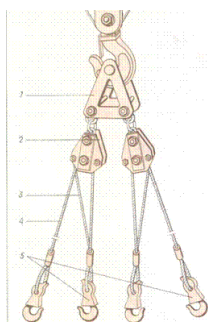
Универсальная траверса 1 — треугольная (пластинчатая) подвеска; 2 — обойма с блоком; 3 — уравнильный канат; 4 — чалочная ветвь стропа; 5 — карабин для расстроповки 346. захваты а, б — вилочные; в, г — петлевые; 7 — стропы; 2 — скобы вилочного захвата; 3 — петли для строповки; 4 — защелка захвата; 5 — отверстие в панели; 6 — петли; 7 — вращаемая планка; 8 — противовес расклинка, вставляемых в отверстия блоков фундамента и блоков стен подвала
